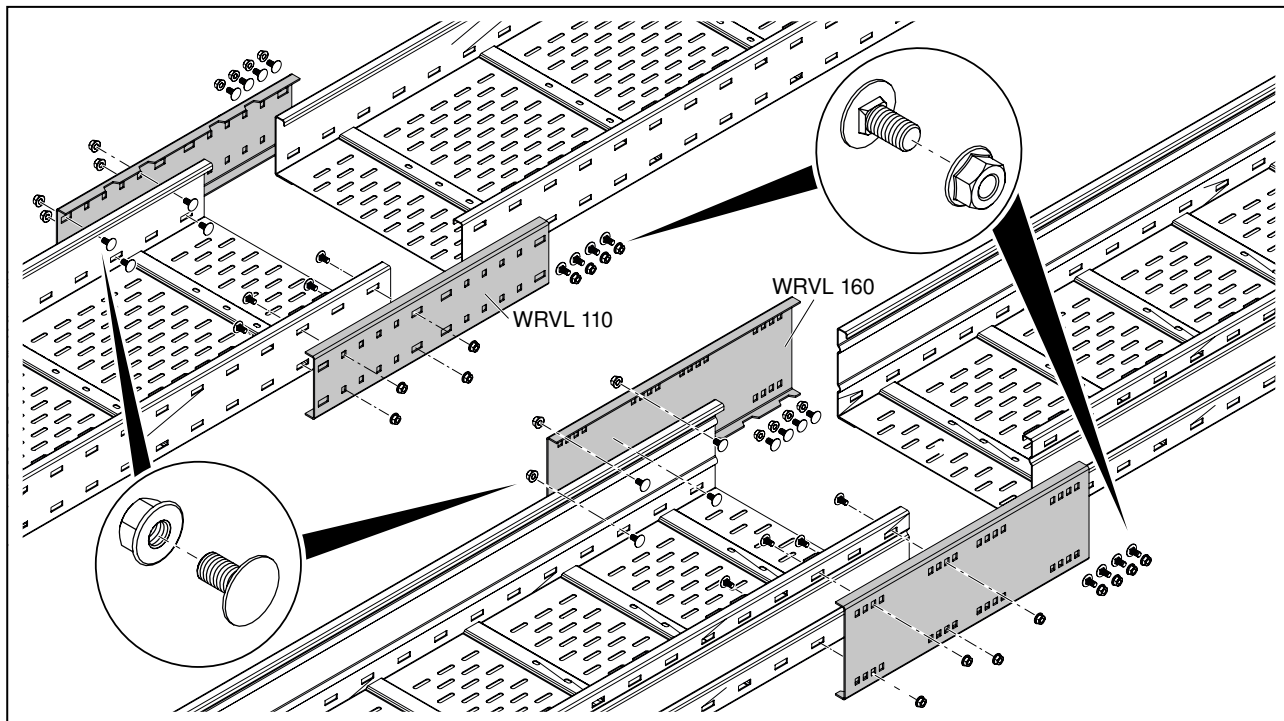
Установка продольных соединителей WRVL 110 и 160
